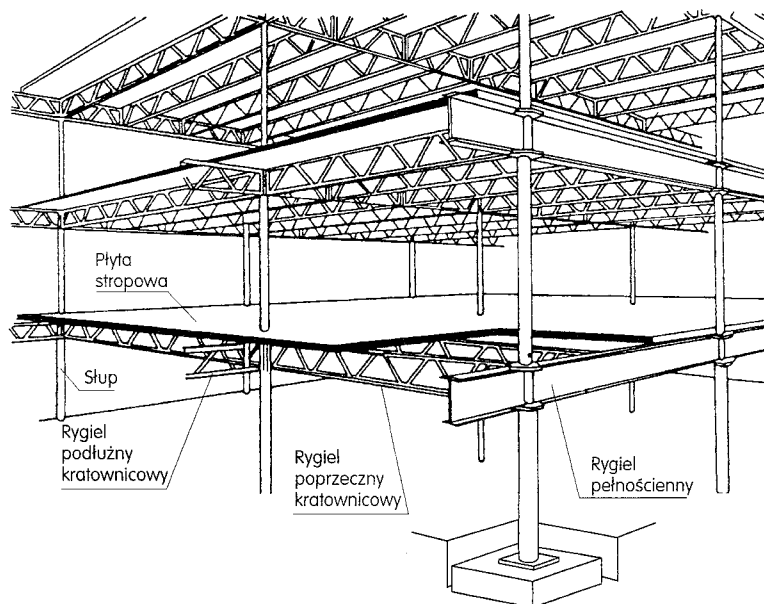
Widok fragmentu konstrukcji szkieletowej ze stropami na belkach i ryglach pełnościennych
